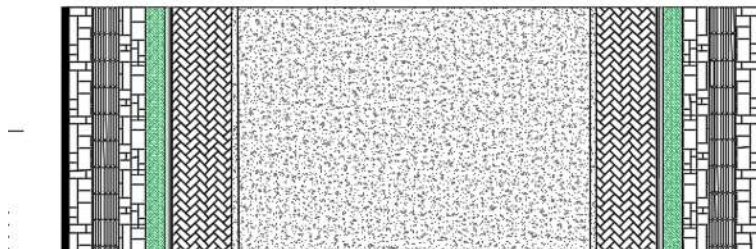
Sección a detalle de calle tipo del plano anexo del Pavimentos DESHAB_PAVIM_08
